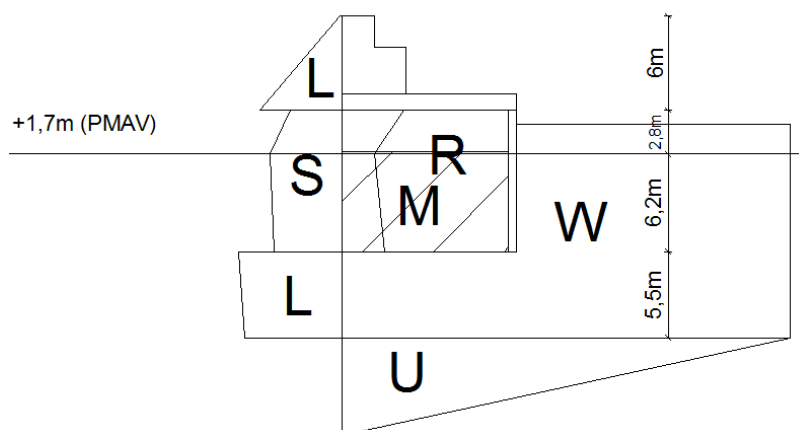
Distribuição de pressões ao longo da parede perfurada e na câmara de ondas da estrutura, (adaptado de CEM, 2006).
